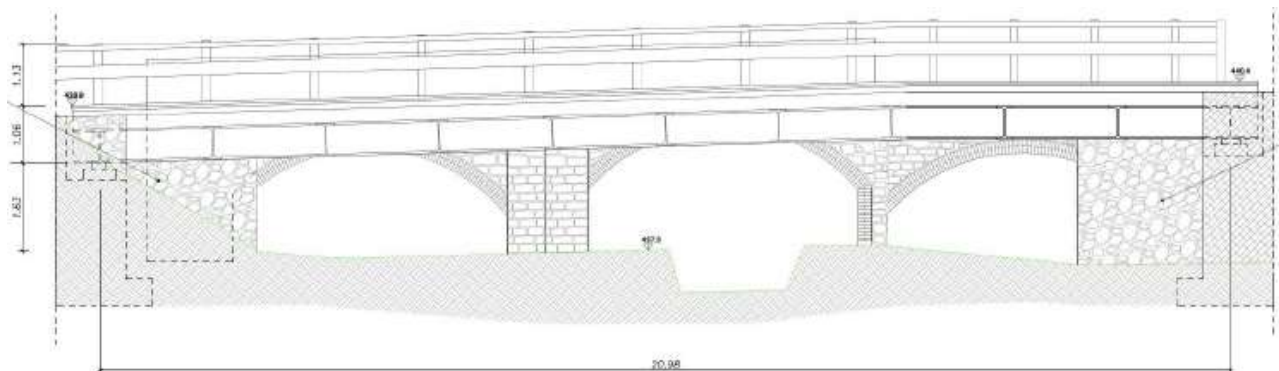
Prospetto ponte in progetto -Vista lato nord (Fonte: Lista di Controllo)
